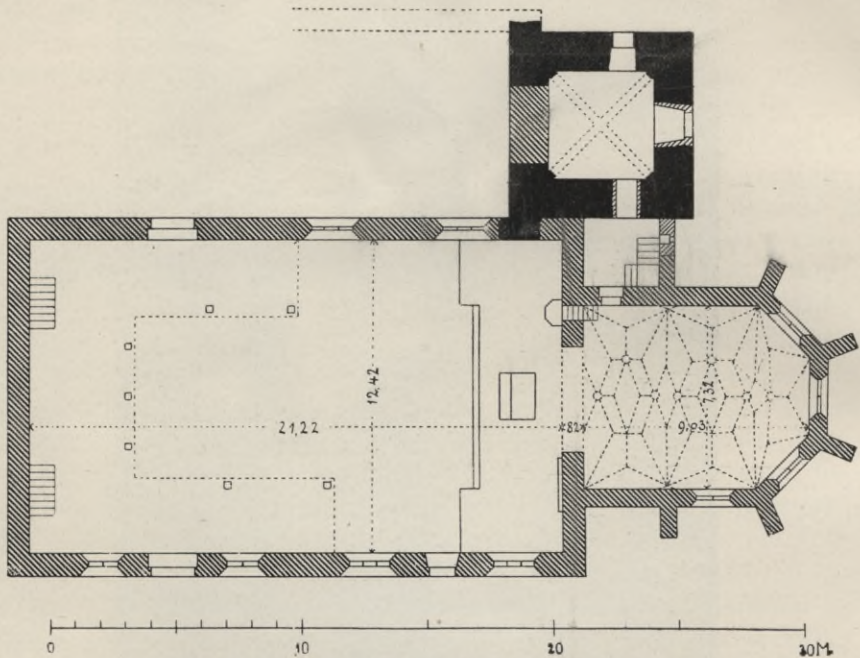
Grundriß der Liebfrauenkirche zu Kürnbach.
